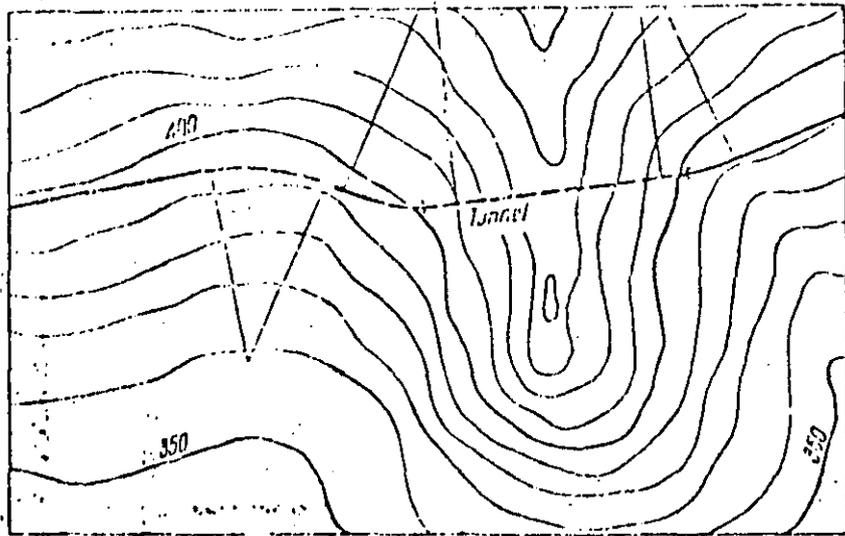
Túneles en estribaciones de montaña (Ref. Szechy)
